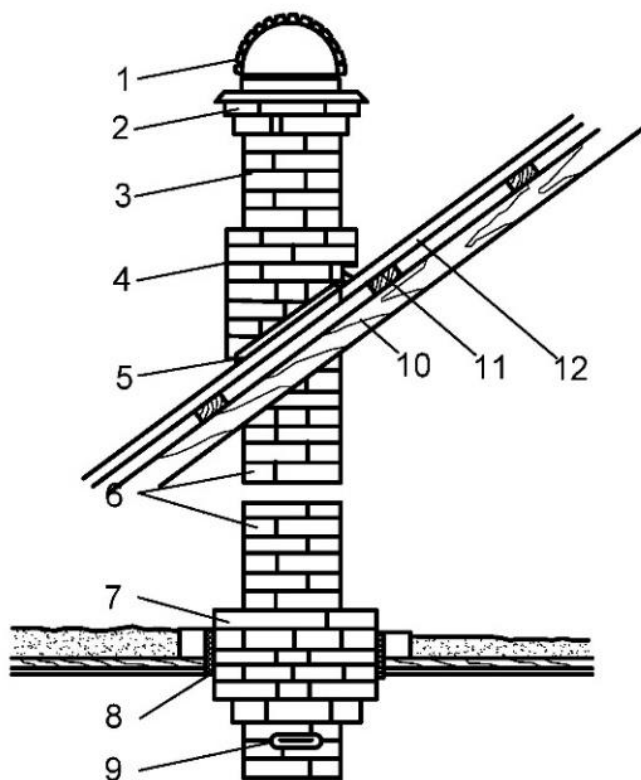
Устройство дымовой трубы: 1 – металлический колпак, 2 – оголовок, 3 – шейка дымовой трубы, 4 – выдра – уширение трубы, защищающее осяк от атмосферных осадков, 5 – слезник – уплотнение из листовой стали, 6 – стояк, 7 – распушка – противопожарная горизонтальная разделка, 8 – войлок или асбест, 9 – печная задвижка, 10 – стропильные балки, 11 – обрешётка, 12 – кровля.
